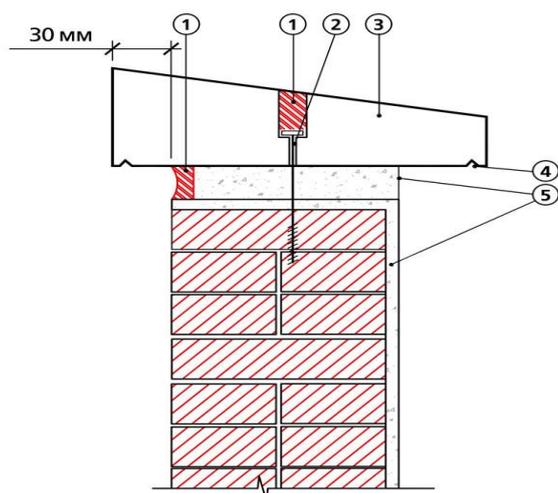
Примыкание кровельного ковра к парапетной стене с парапетным камнем:
